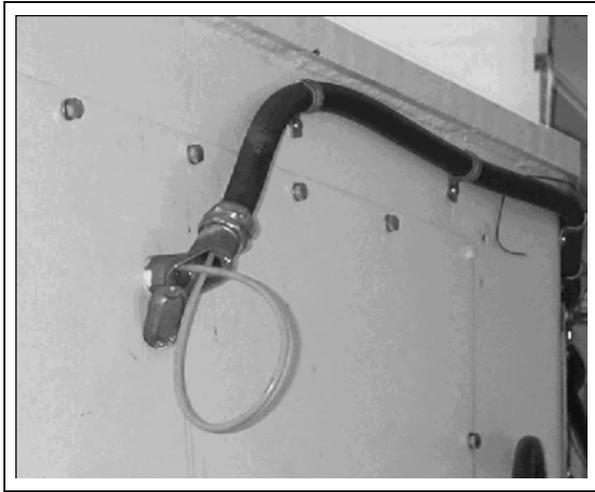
Tirage d'un câble à l'intérieur d'un conduit semi-rigide
